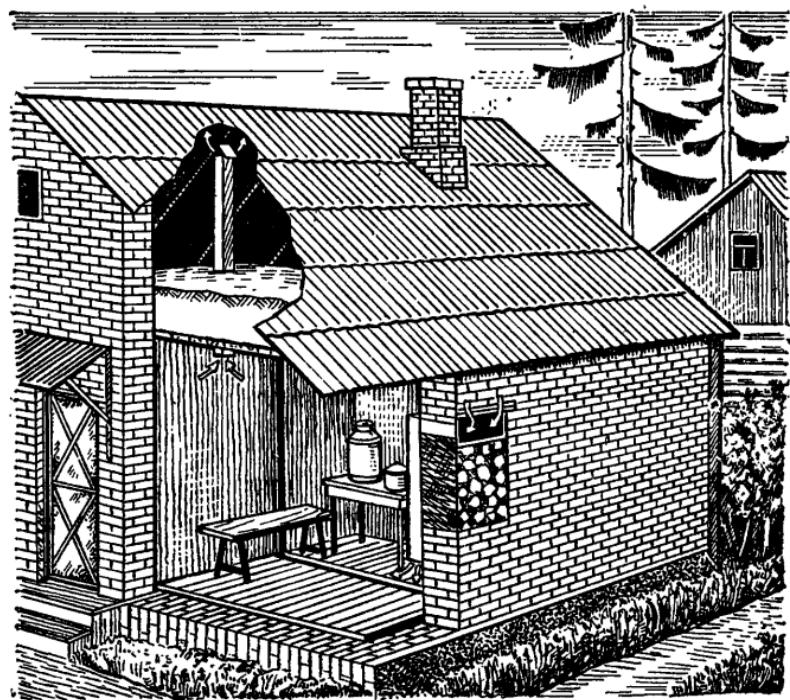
Наземное здание, приспособленное под противорадиационное укрытие
